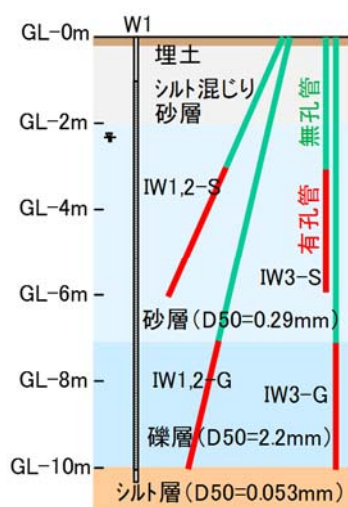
微粉末樹脂ペーストの添加状況      図-1 試験サイトの土質性状      図-2 井戸・注入管配置平面図
